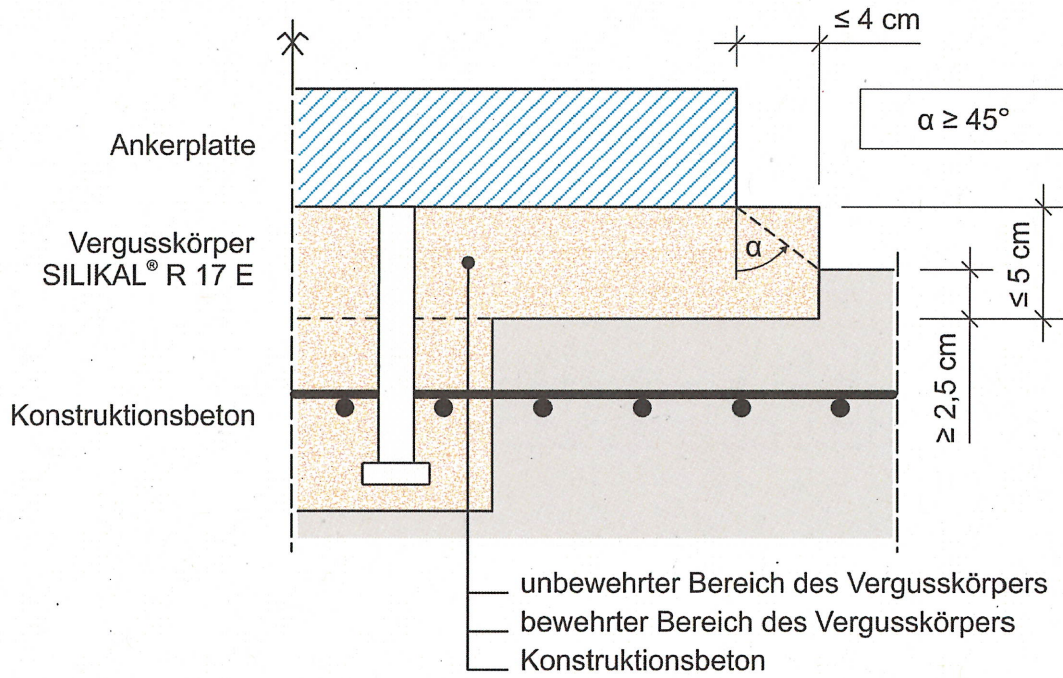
Anwendungsbeispiele – Vergussbereichsweise unbewehrt
